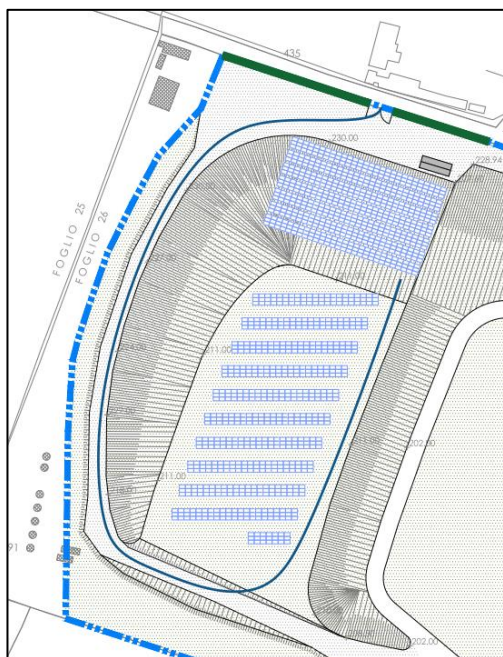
Estratto planimetria di progetto impianto fotovoltaico
